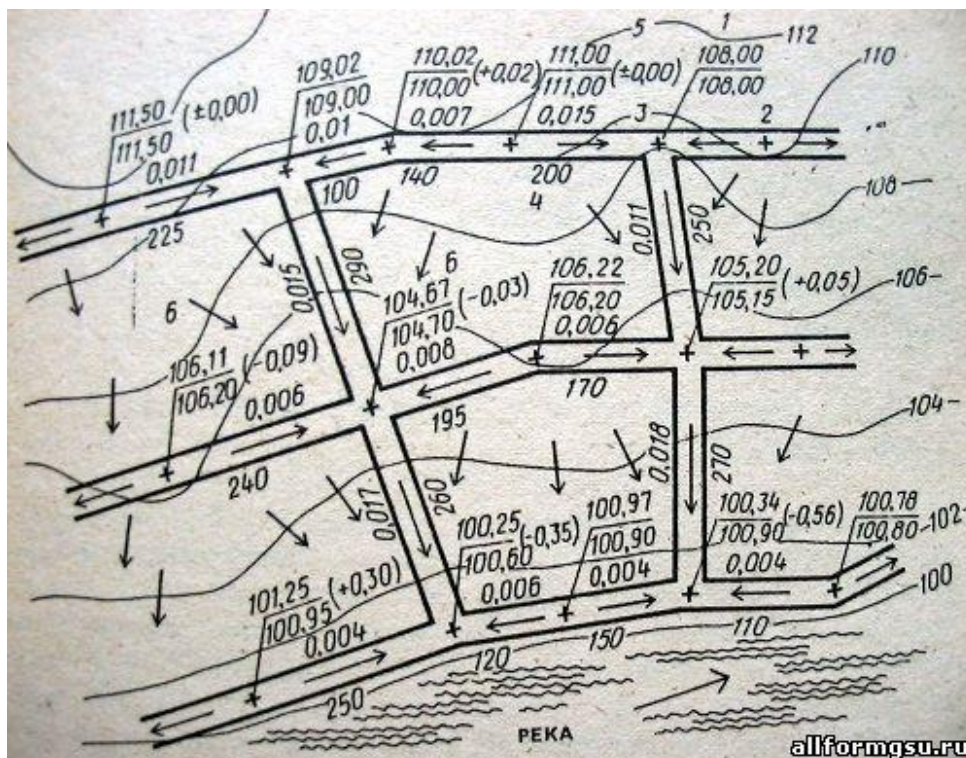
Схема вертикальной планировки, выполненная методом проектных (красных) отметок
